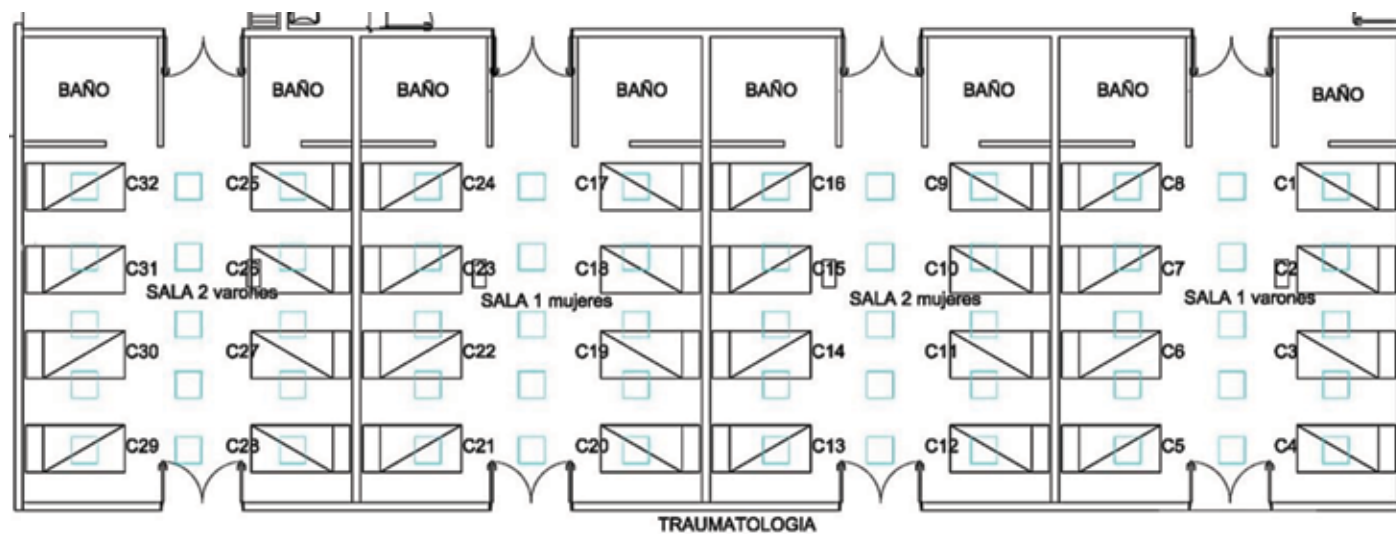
Edificio 2, plano orientación Sur. Planta baja
